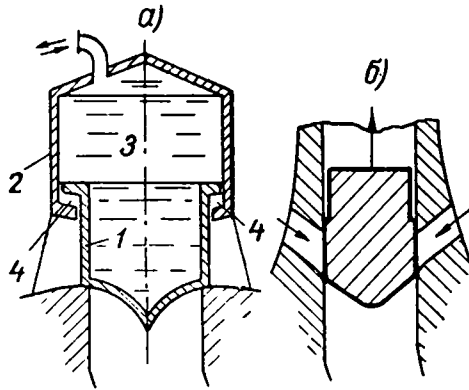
10. Затопленный цилиндрический открытый затвор
